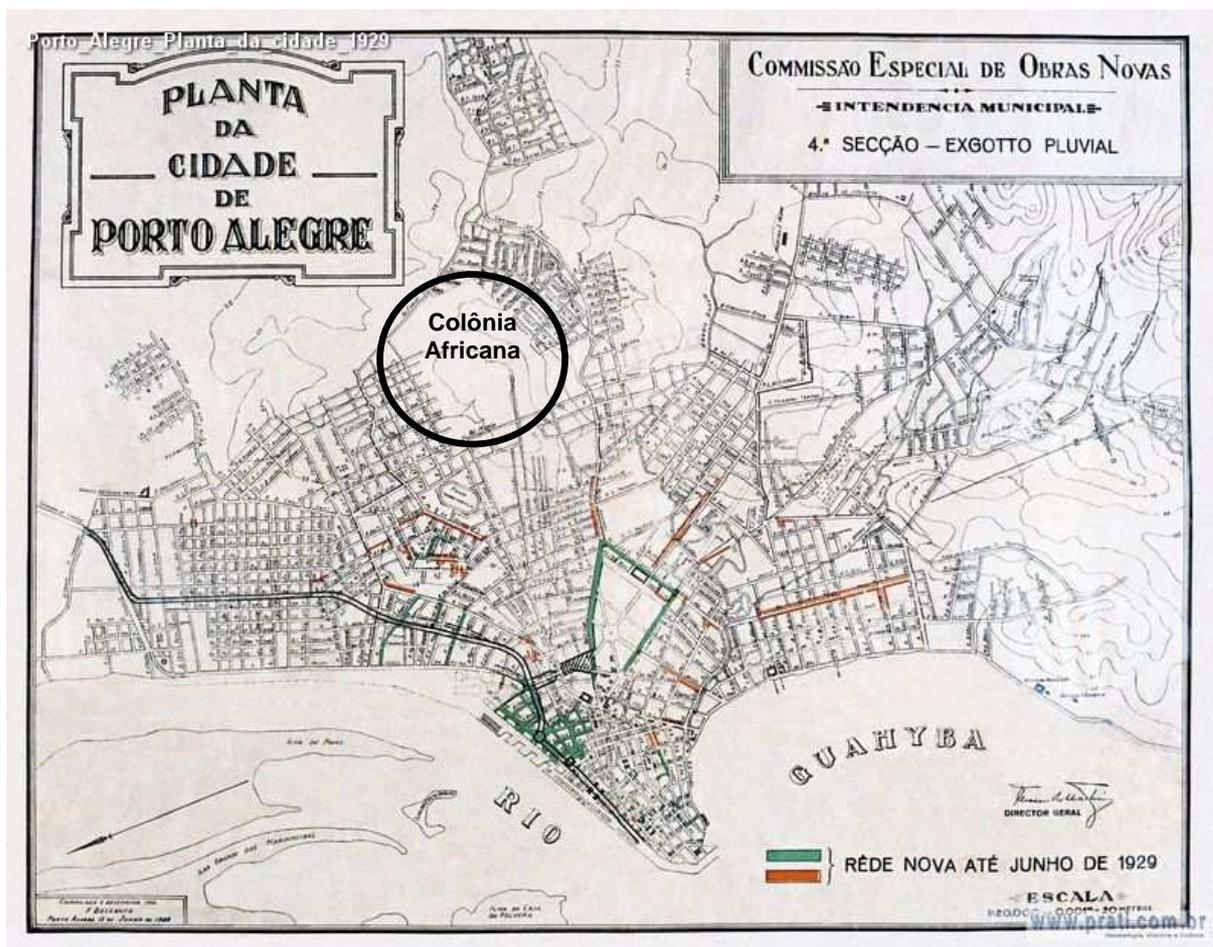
Planta de Exgoto Pluvial Porto Alegre de 1929 – disponível em <http://www.prati.com.br>
